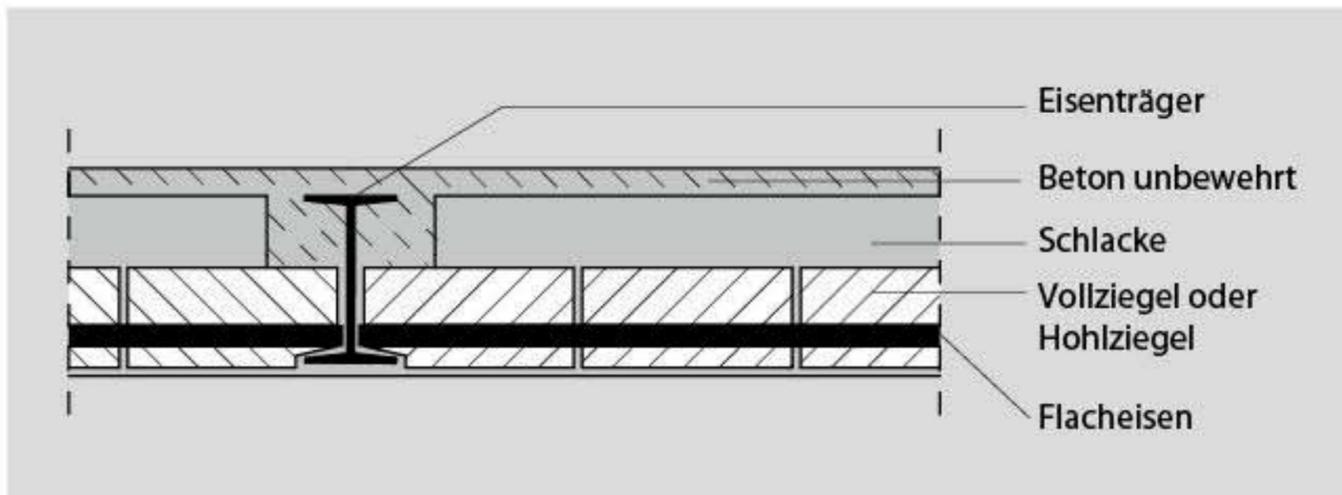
Konstruktionsaufbau einer Kleinerschen Decke
